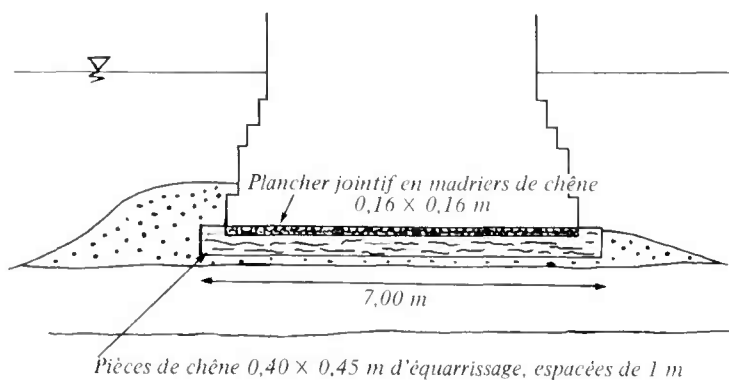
Pont Neuf - Fondation d'une pile
